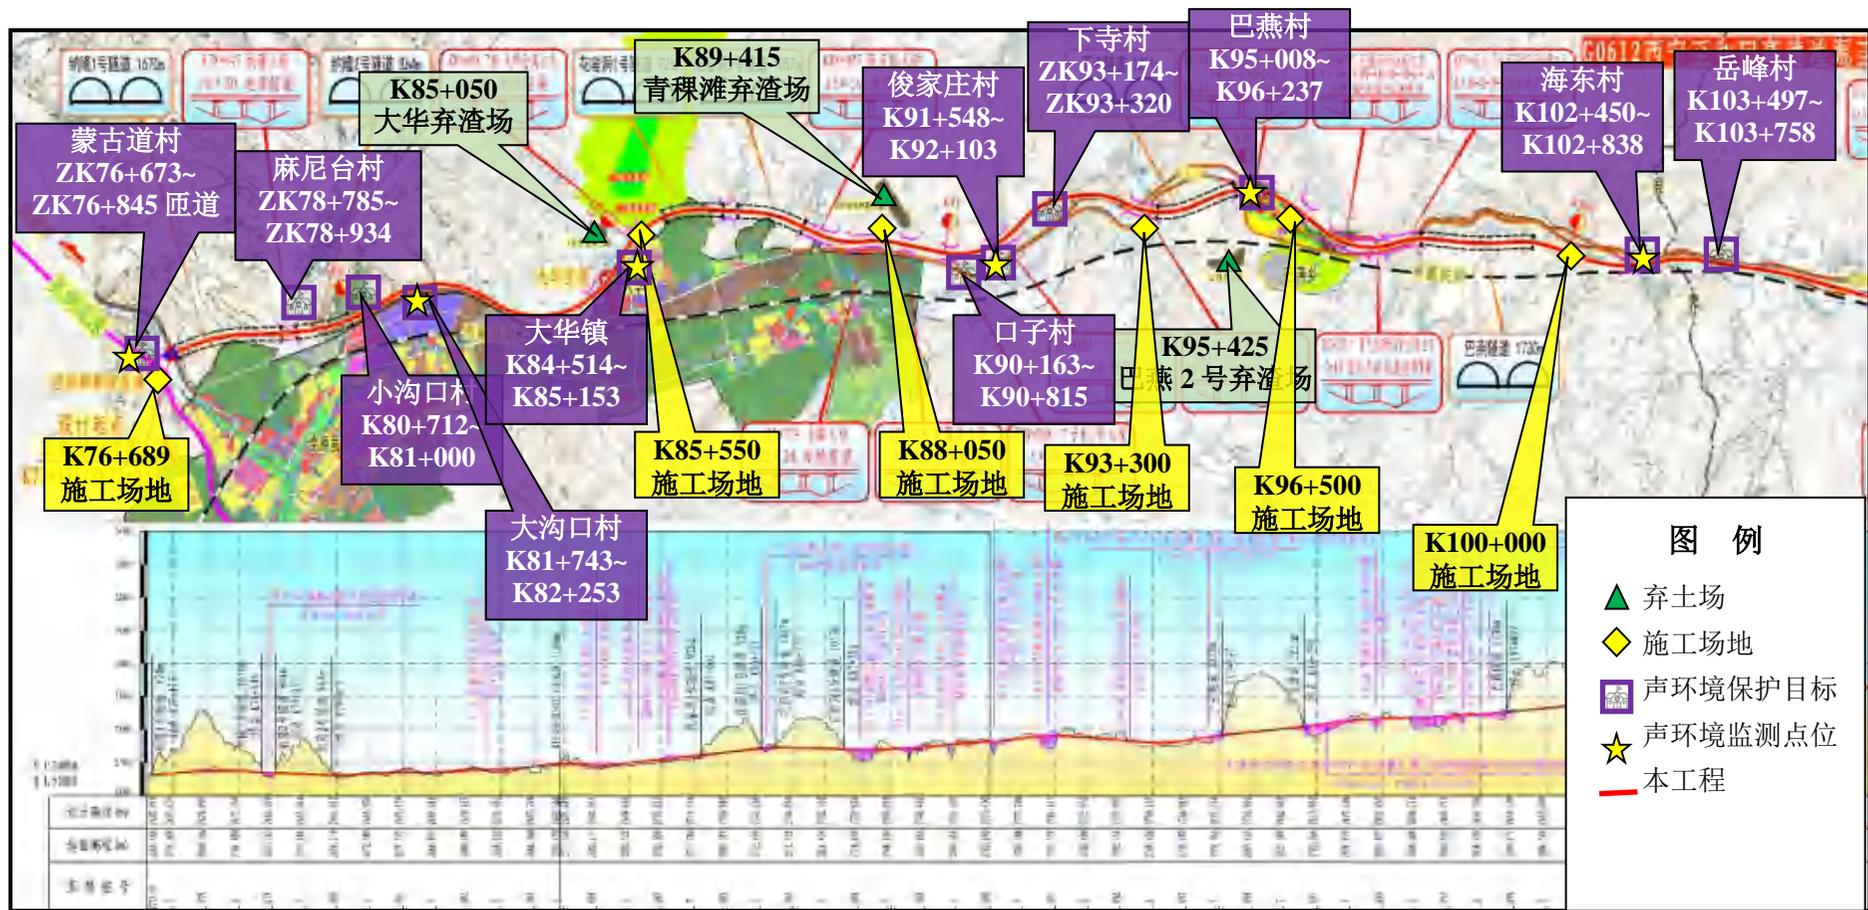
本工程路线走向及线位总体平面布置示意图 (1)
